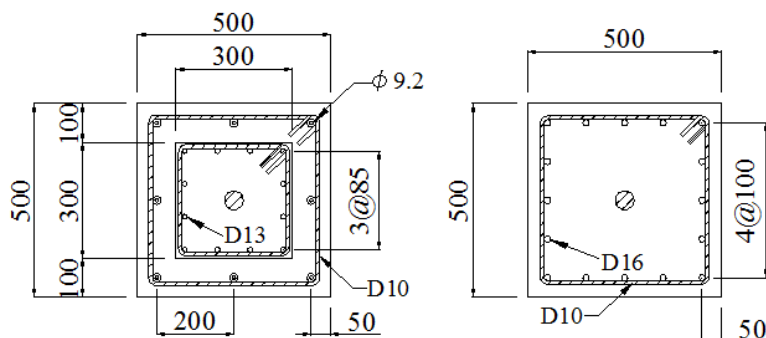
HPCaPRC 断面（単位：mm） 図-2 RC 断面（単位：mm）
